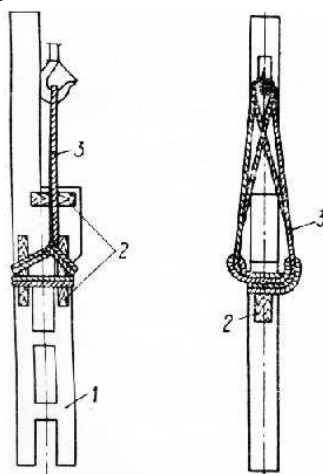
а – Строповка колонн универсальным стропом
